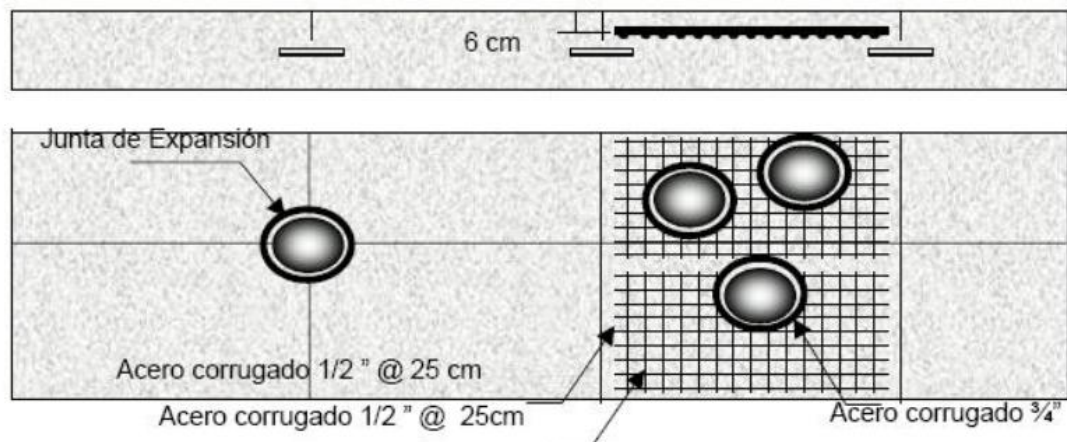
Refuerzo de losas de forma irregular o con estructuras fijas en su interior
